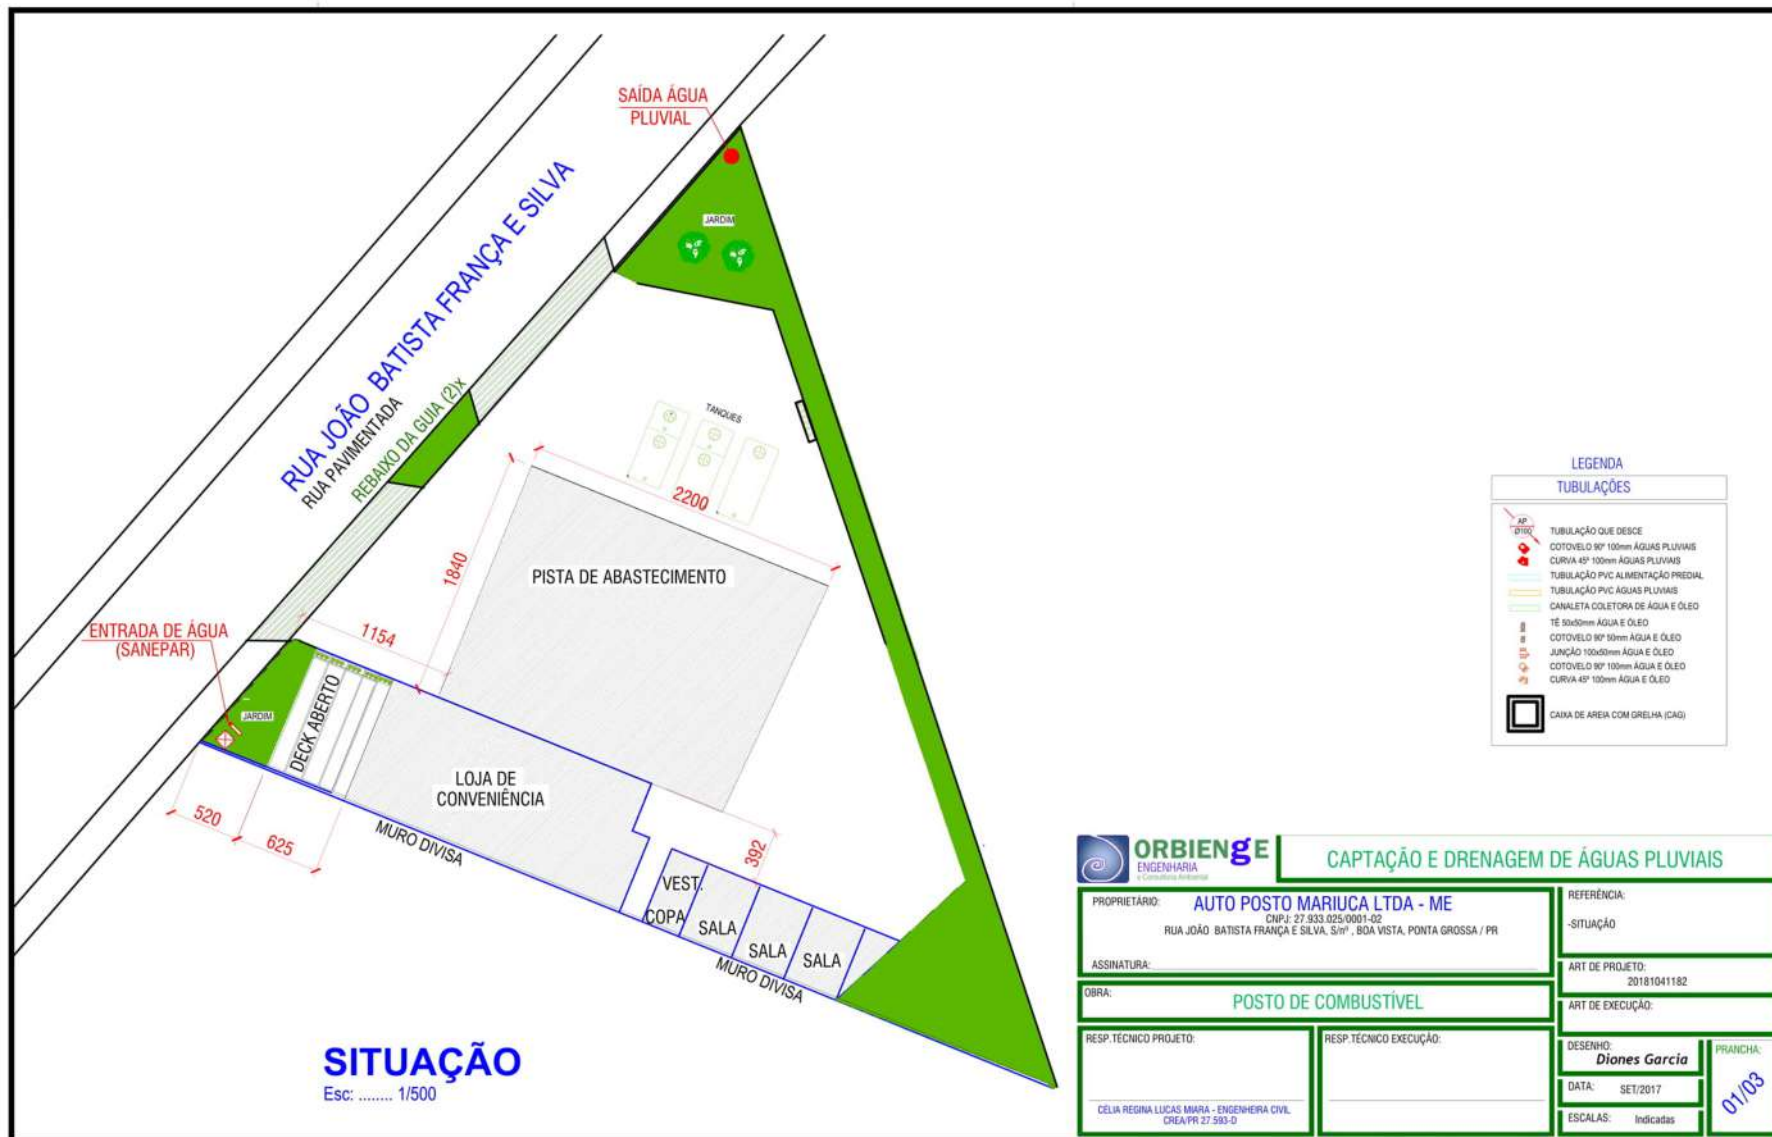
Projeto de drenagem de águas pluviais – Implantação.
